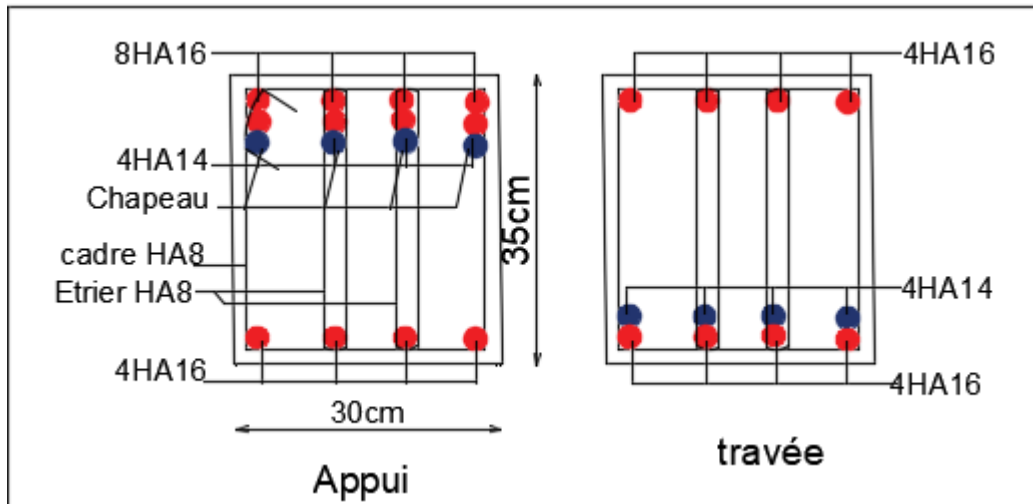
Schéma de ferrailage de la poutre secondaire du plancher étage 1
